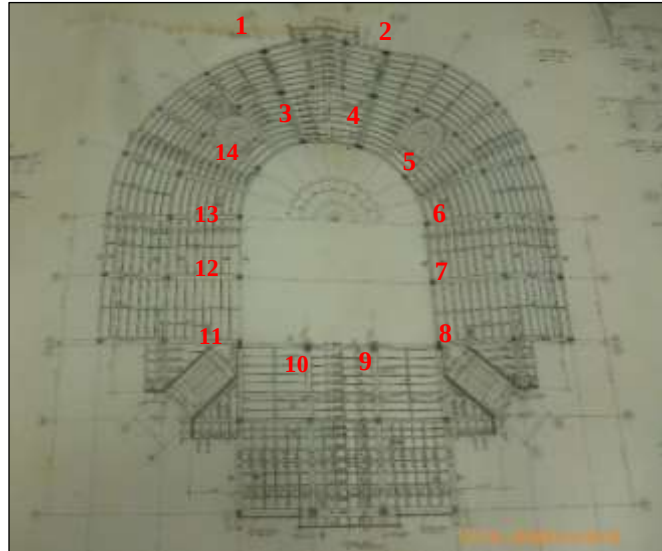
Fuente: autores, plano por Ing. Navas Carlos, (2018), Plano original de placa en primer nivel, es el orden de los elementos objeto de estudio del ladrillo de revestimiento Alcaldía Yopal.
